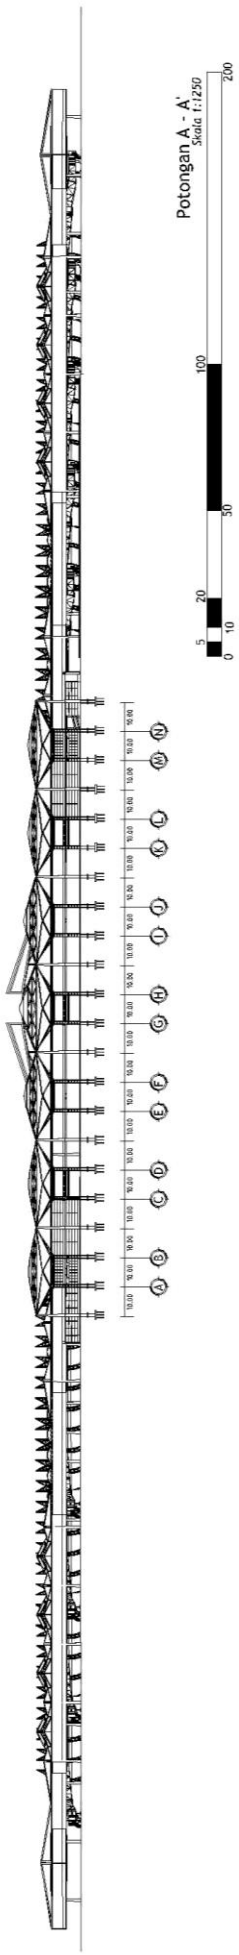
Tampak Terminal zona *Airside* alternatif 2
